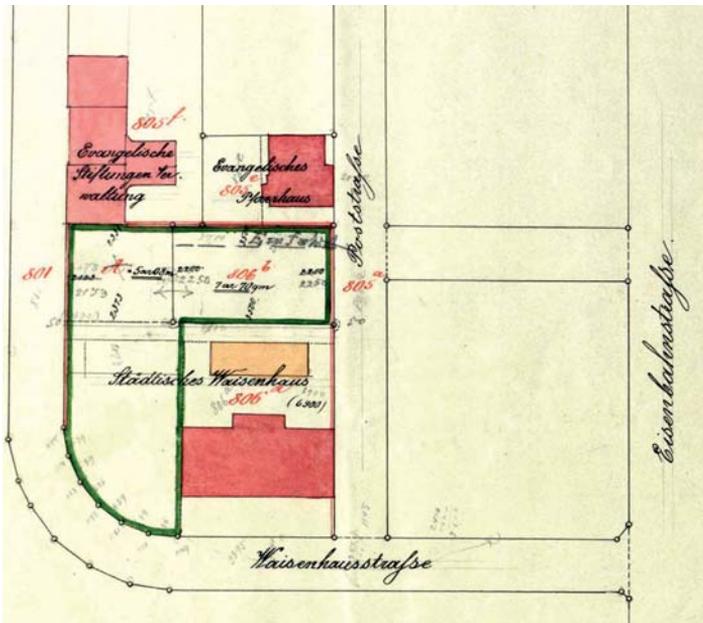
¹⁵ Grundstücksplan des Offenburger Waisenhauses.
